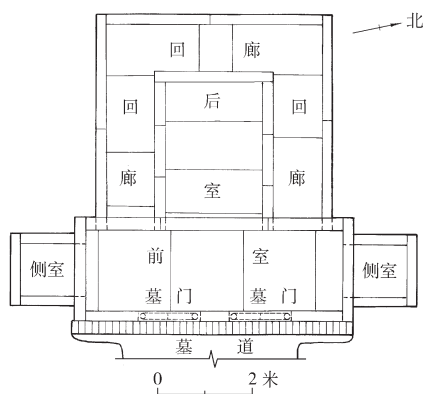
山东省济宁市普育小学汉墓平面图 (1/1500)
